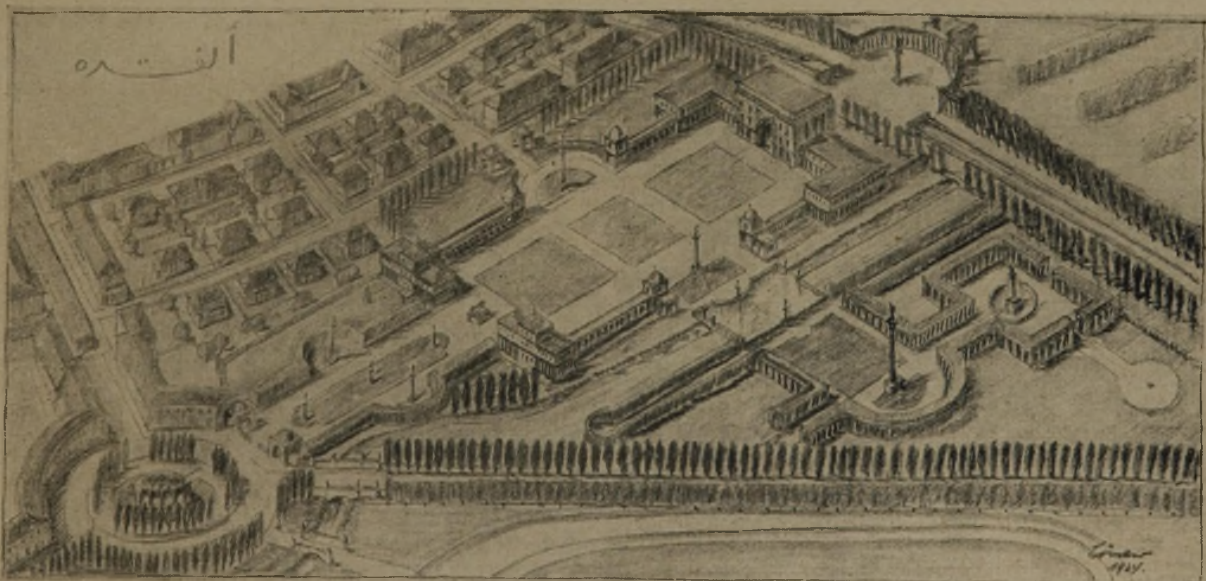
Stadtgarten mit Ausstellungsgelände.
